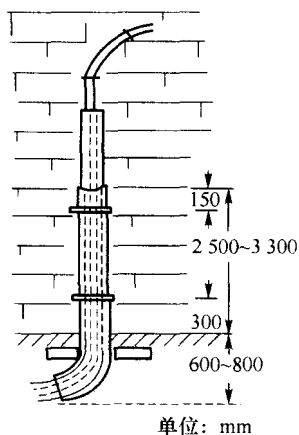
光(电)缆墙壁引上安装示意图
